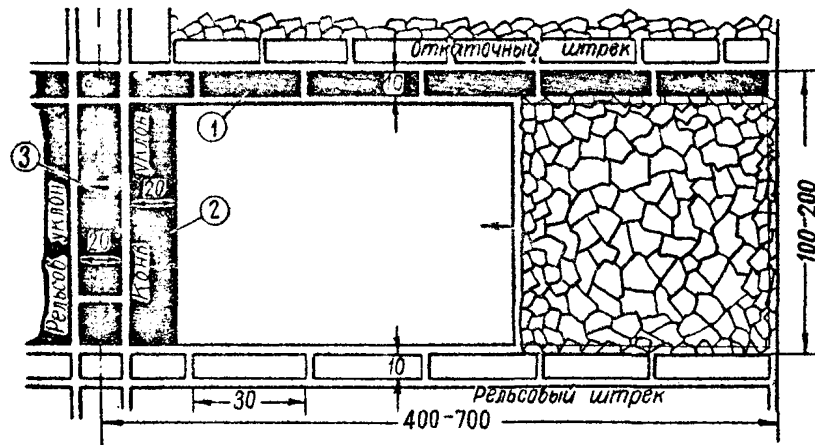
Рис. I. Система разработки длинными столбами по простиранию с обрушением кровли
